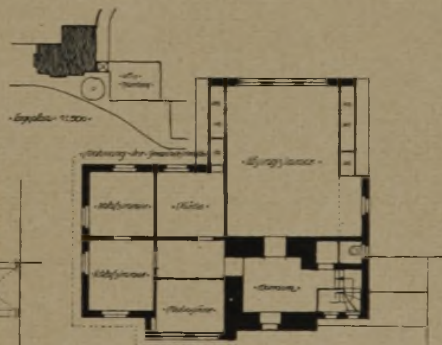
(links.) Grundriß des neuen Gemeindehauses. Obergeschoß mit Lageplänen. (1 : 400.)
